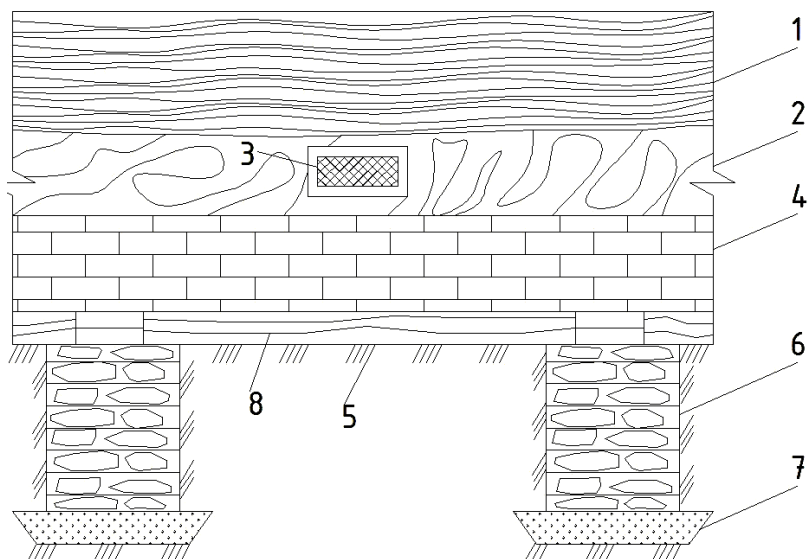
Принципиальная схема сопряжения кирпичной кладки цокольной части стены по деревянной балке и бутовым столбам фундамента:
